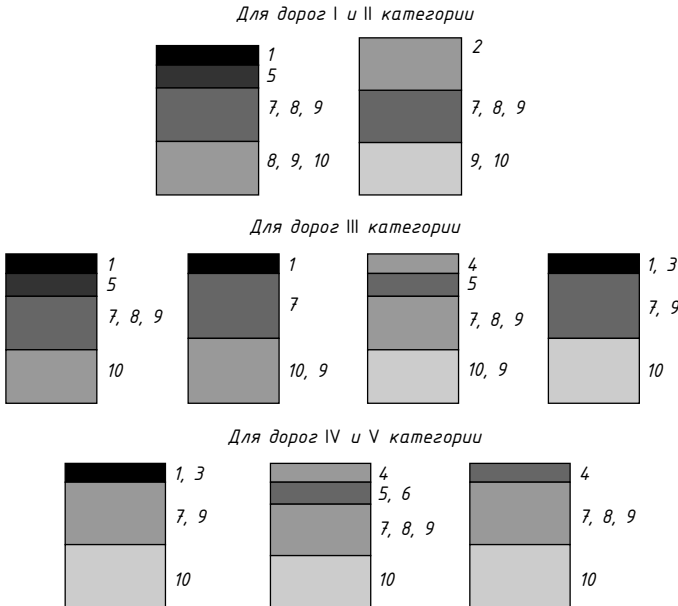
Конструкции дорожных одежд со слоями из укрепленных грунтов: 1 — одно- или двухслойное асфальтобетонное покрытие; 2 — цементобетонное покрытие; 3 — покрытие из битумоминеральной смеси; 4 — поверхностная обработка или тонкий защитный слой; 5 — черный щебень; 6 — покрытие, устроенное методом смешения или пропитки; 7 — основание или покрытие из грунта, укрепленного комплексными вяжущими; 8 — основание или покрытие из грунта, укрепленного органическими вяжущими; 9 — основание или покрытие из грунта, укрепленного минеральными вяжущими; 10 — слой основания из песка или крупнообломочного материала
